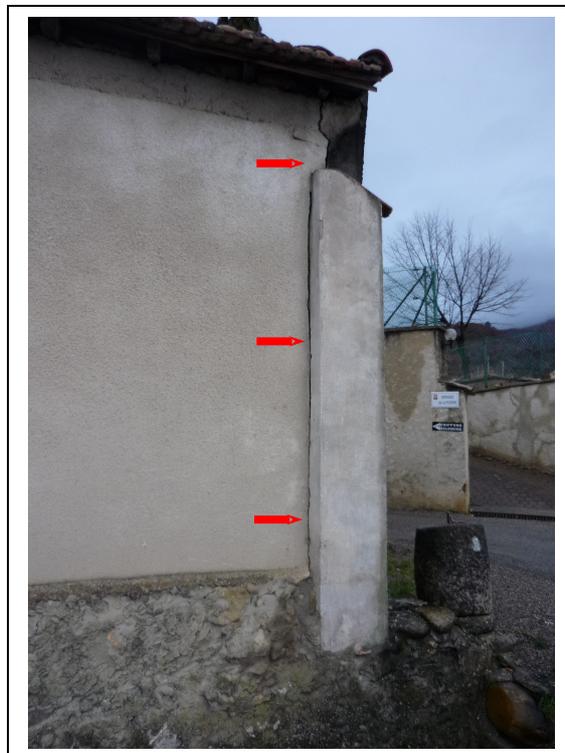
Fissures sur une construction (secteur de la Pierre) [Source : IMS_{RN}]
